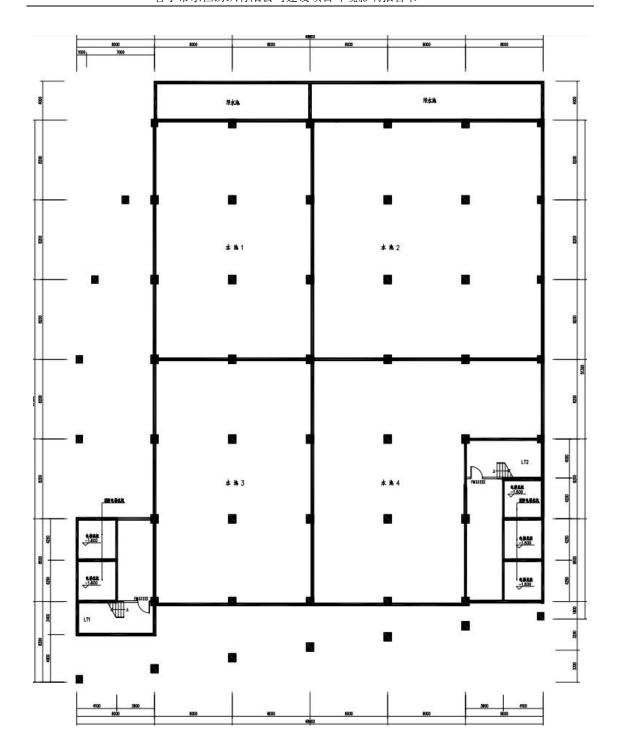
原有项目 (B 栋厂房) 负 1 楼平面布置图
